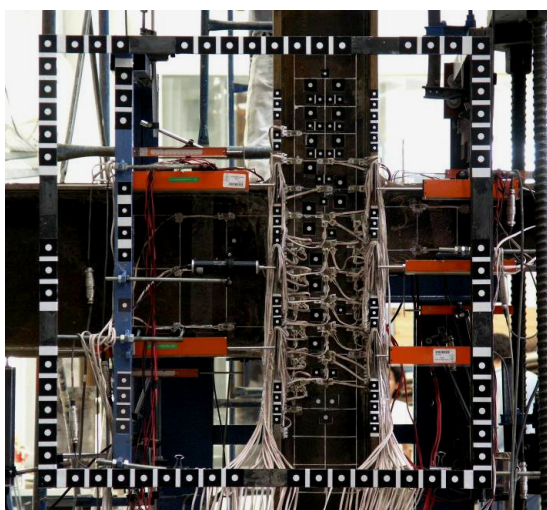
Caracterização do estado de deformação ao longo do ensaio, na alma da secção instrumentada do pilar
